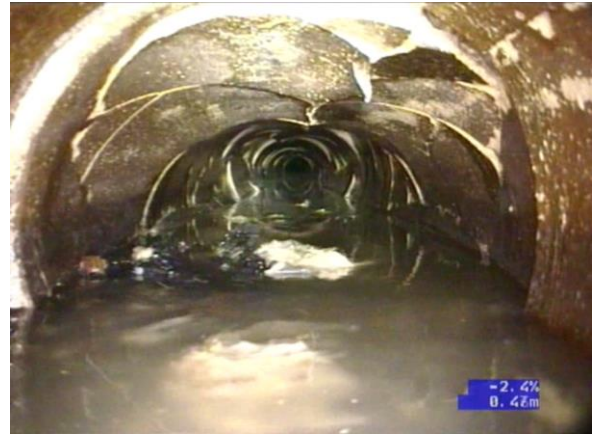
Fissuras de grandes dimensões multidirecionais e deformação grave com deslocação de secções partidas – Colapso Eminente
